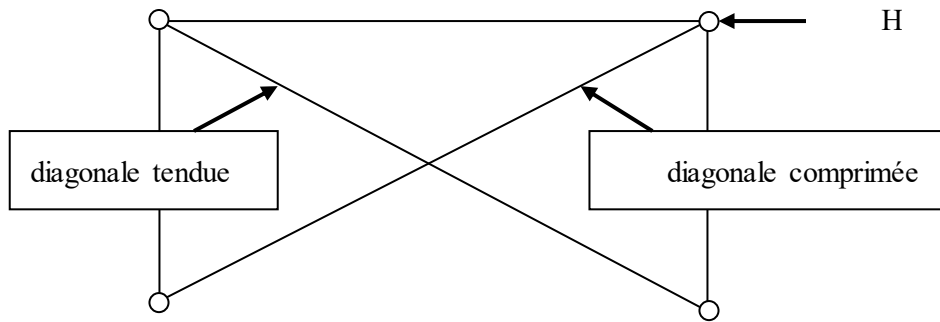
portique poteau poutre à liaison articulée et stabilisé par palée de stabilité
